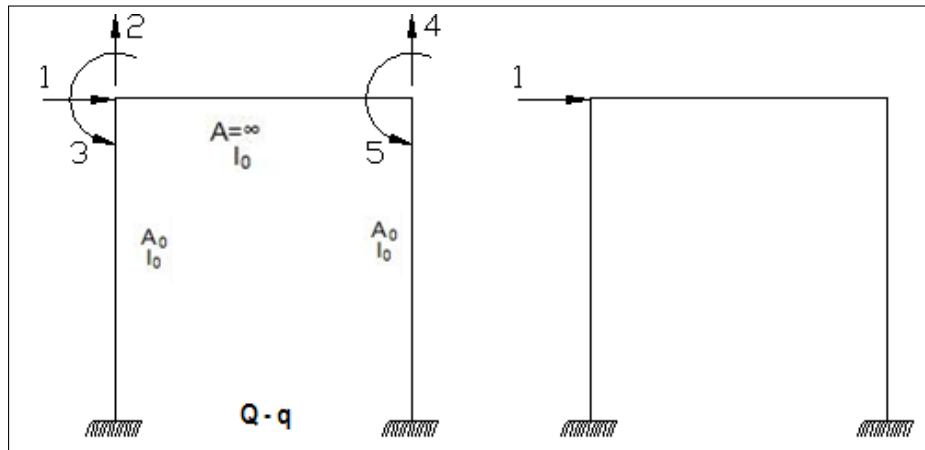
Coordenadas a y b, de un pórtico plano.<sup>48</sup>
